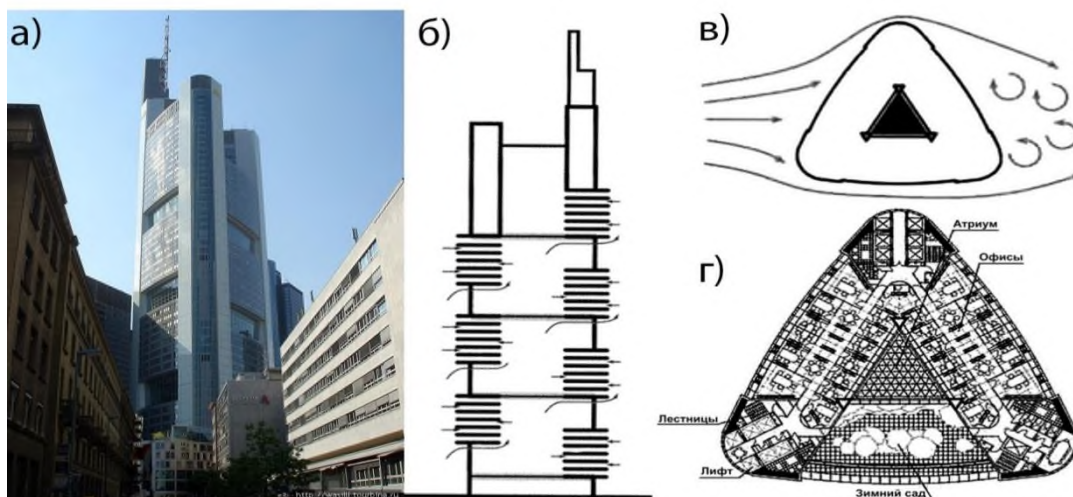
Офисное здание «Коммерцбанк» во Франкфурте-на-Майне, Германия. Архитектор Норман Фостер, 1997 г.: а) общий вид; б) разрез; в) схема движения потоков воздушных масс вокруг здания; г) план 1-го этажа [5]
